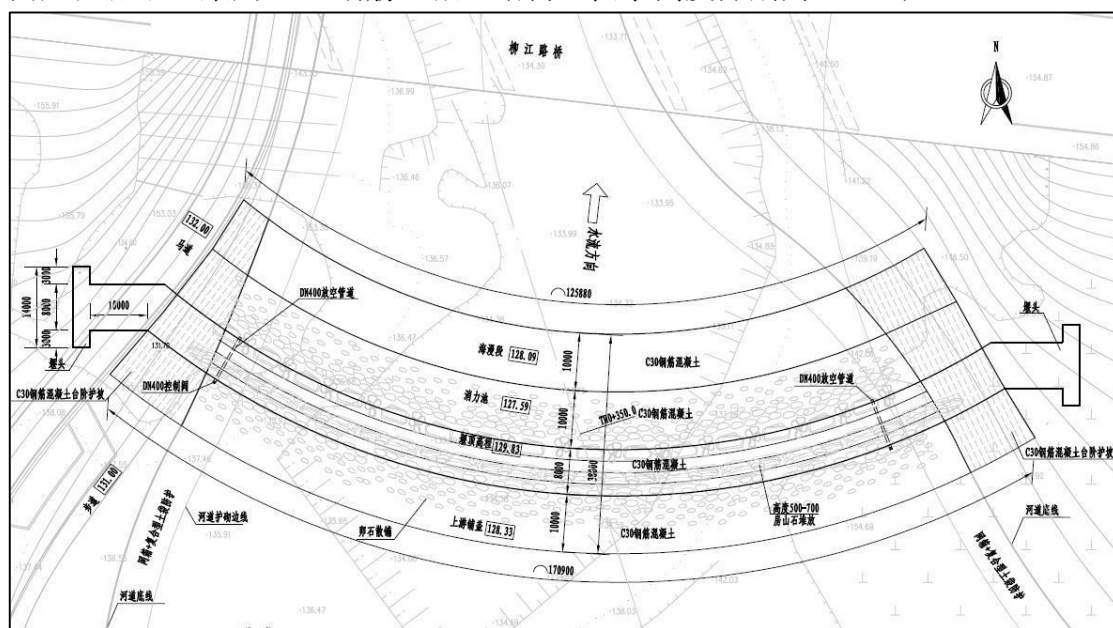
1#溢流堰（TX0+350）平面布置图
